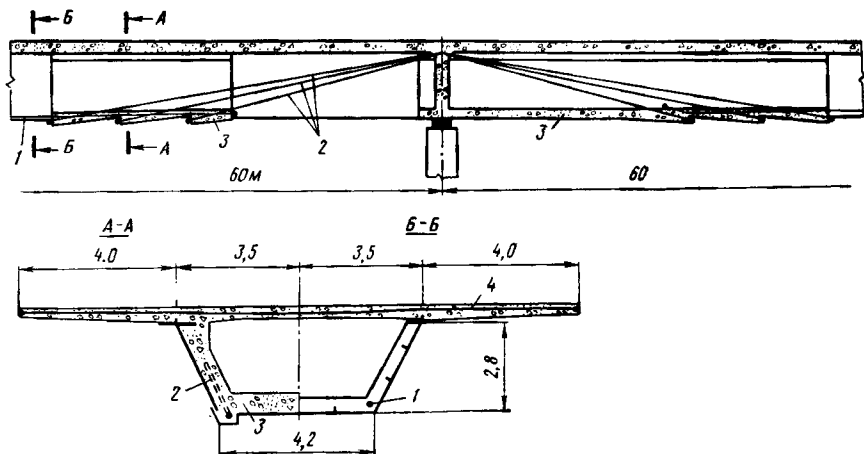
Конструкции сталежелезобетонного пролетного строения с предварительно напряженной арматурой в плите и главной балке:
